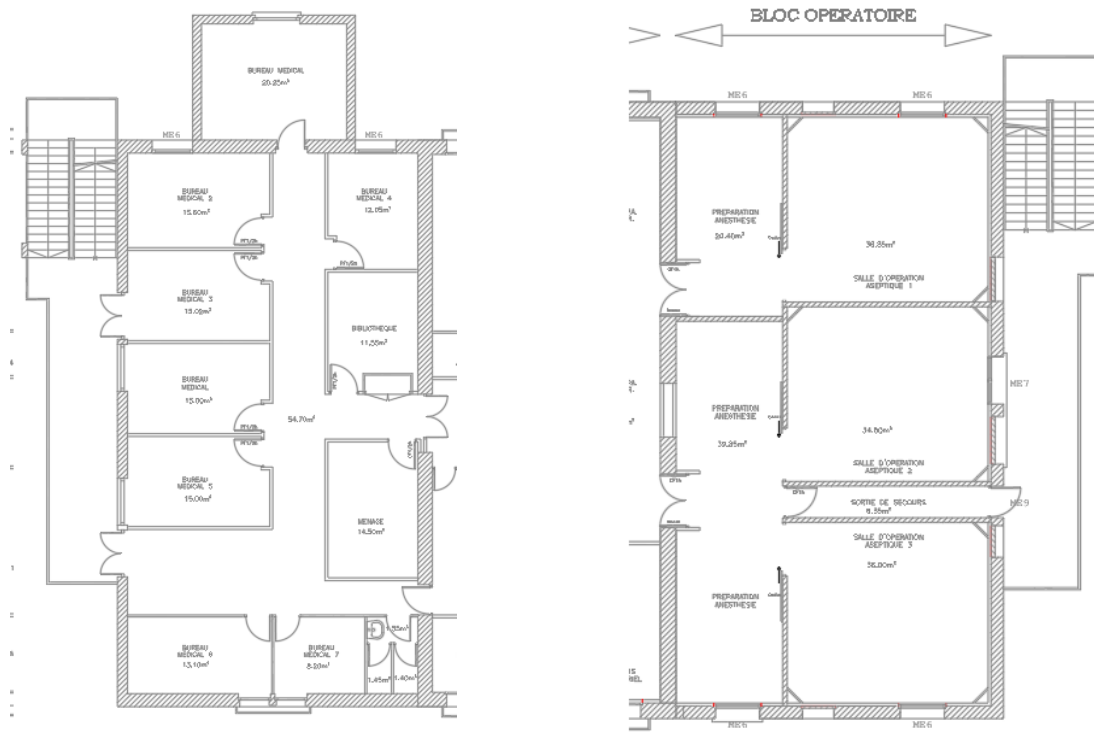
& 15 : Extrait plan archi R+1 aile Ouest & Est
